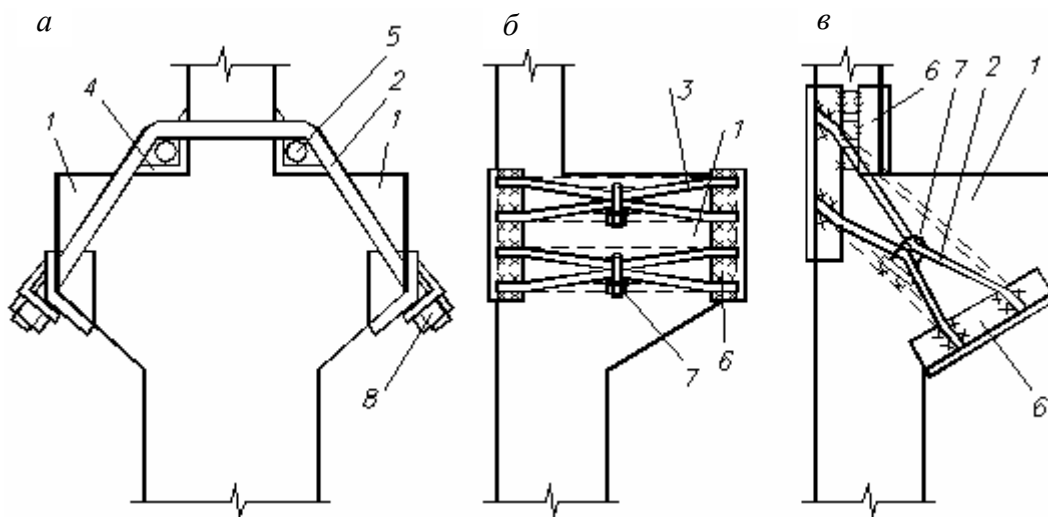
Усиление коротких консолей колонн установкой дополнительной предварительно напряженной поперечной арматуры: а, в – наклонной; б – горизонтальной, 1 – усиливаемая консоль, 2 – наклонная арматура, 3 – горизонтальная арматура, 4 – уголок-накладка, 5 – упор, 6 – уголок, 7 – стяжной болт, 8 – гайка
